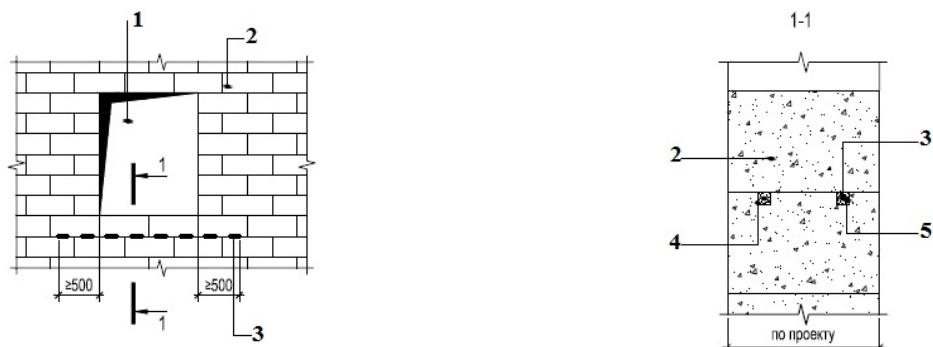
Дополнительное армирование подоконной части кладки стен из газобетонных блоков: 1 — оконный проем; 2 — блоки YTONG; 3 — арматура  $\varnothing 6$  мм; 4 — штраба; 5 — цементный раствор
